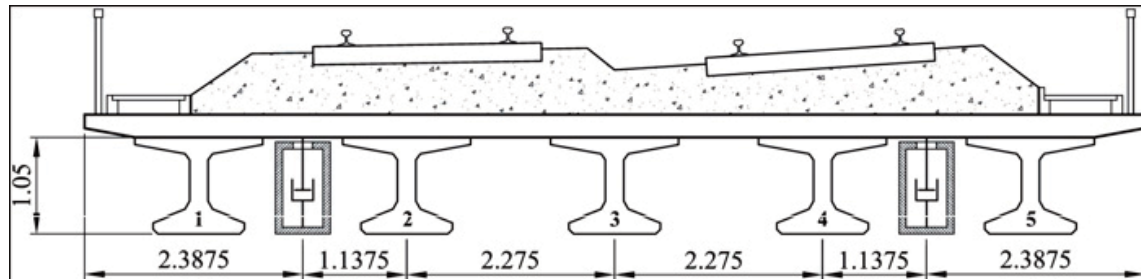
Ubicación propuesta de las vigas auxiliares en el puente Arroyo Bracea II
